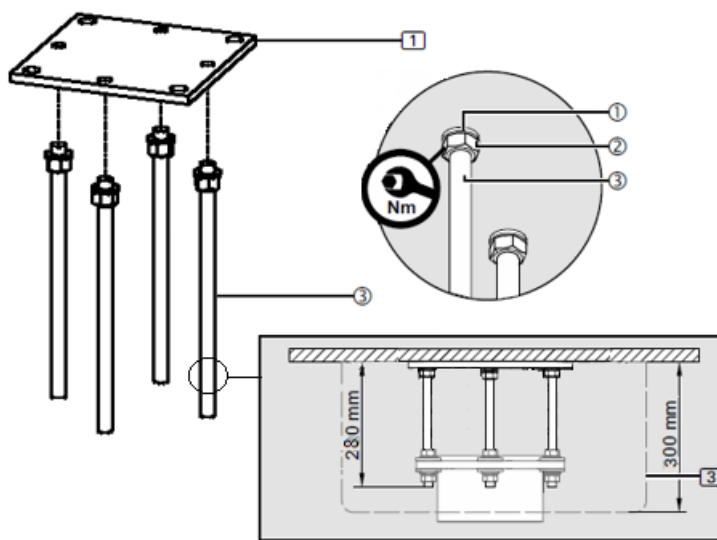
Installation de la plaque d'interface sans faux plafond pour les ARBRES FIXES AU PLAFOND
